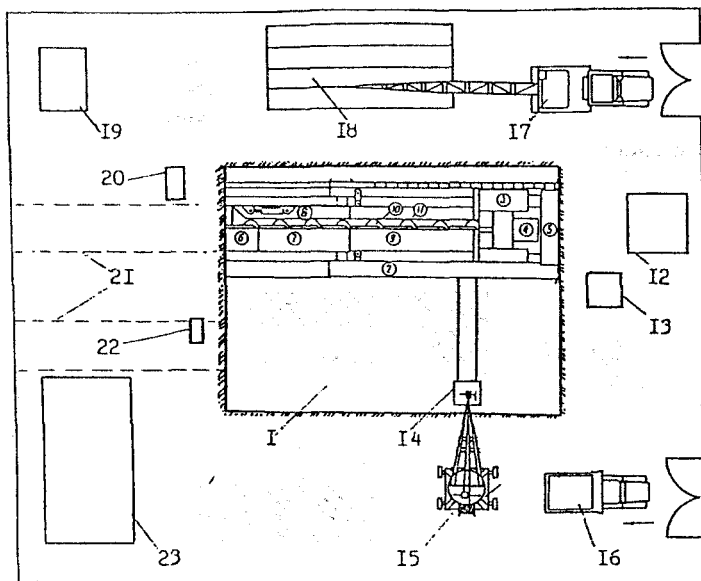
Схема размещения оборудования на строительной площадке при закрытой прокладке теплопроводов:
